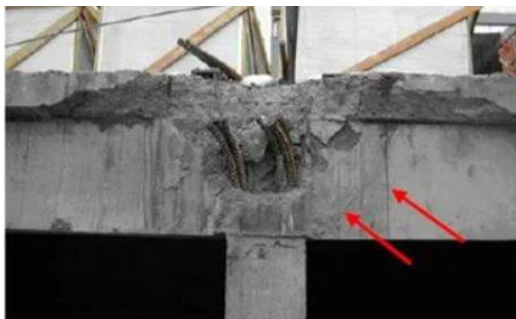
Разрушение узла сопряжения основных ригелей перекрытия
